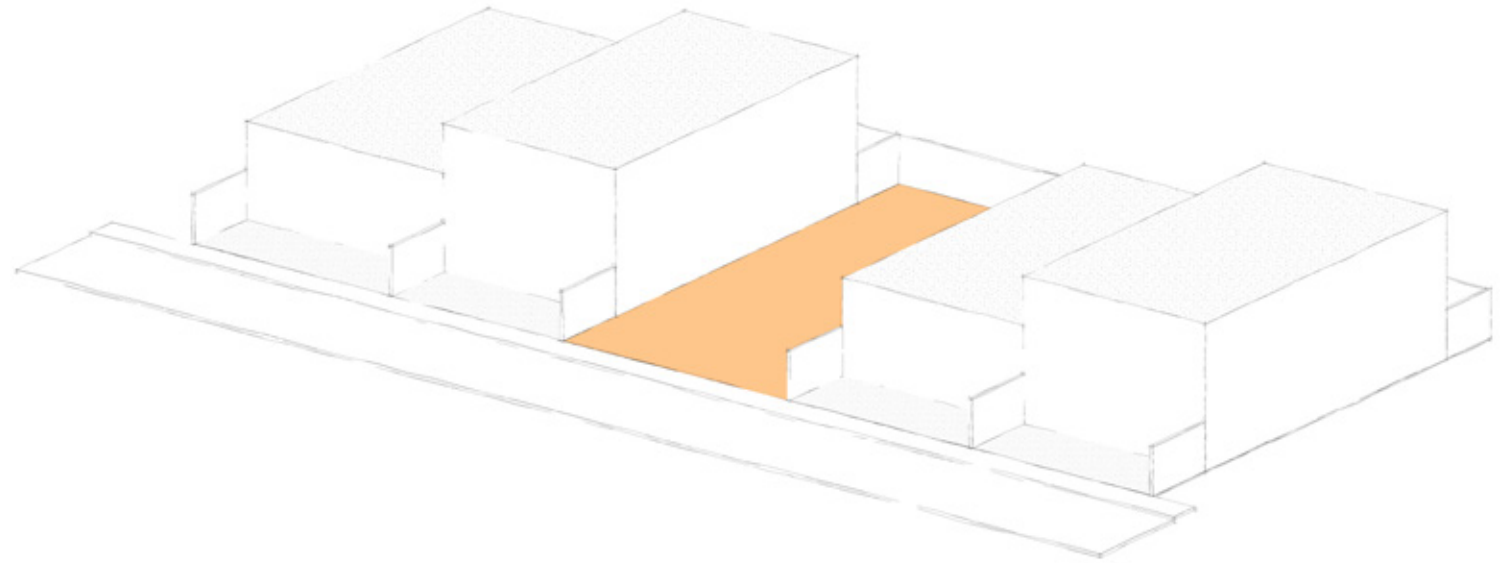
Axonometría Lote Tipo. Fuente: Autores, 2023
